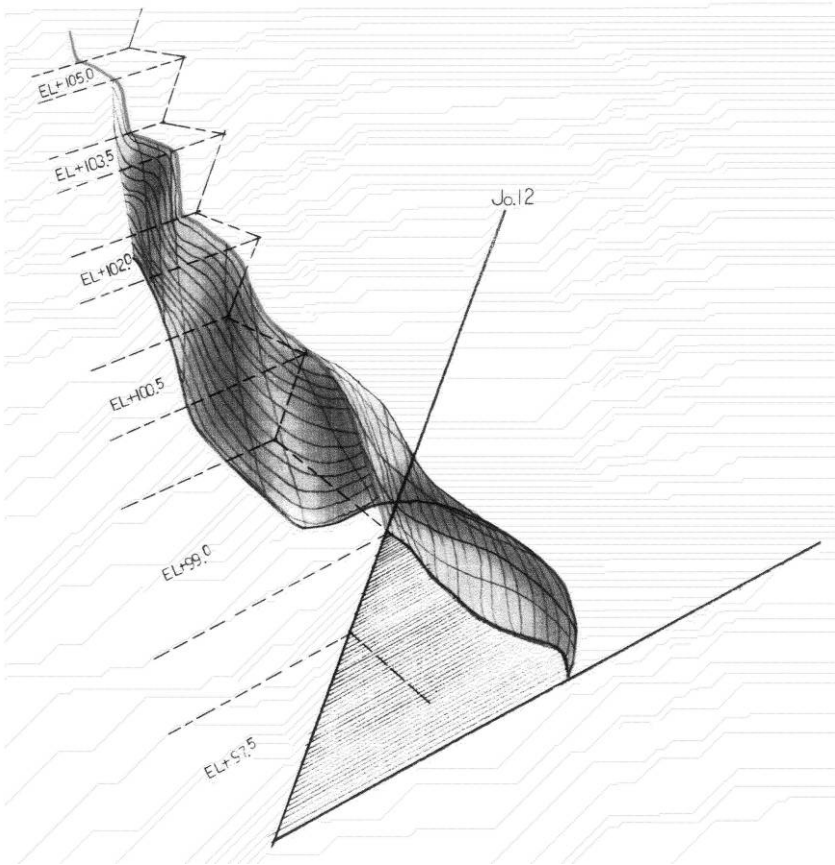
ひび割れ面透視図(13BL-1)
